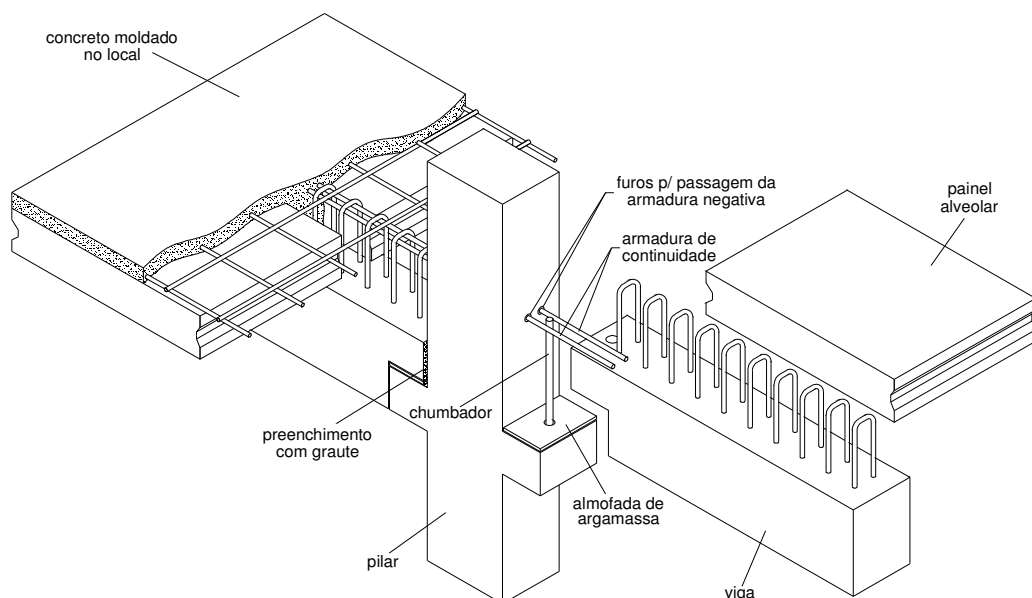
Ligação viga-pilar estudada por Miotto (2002)
